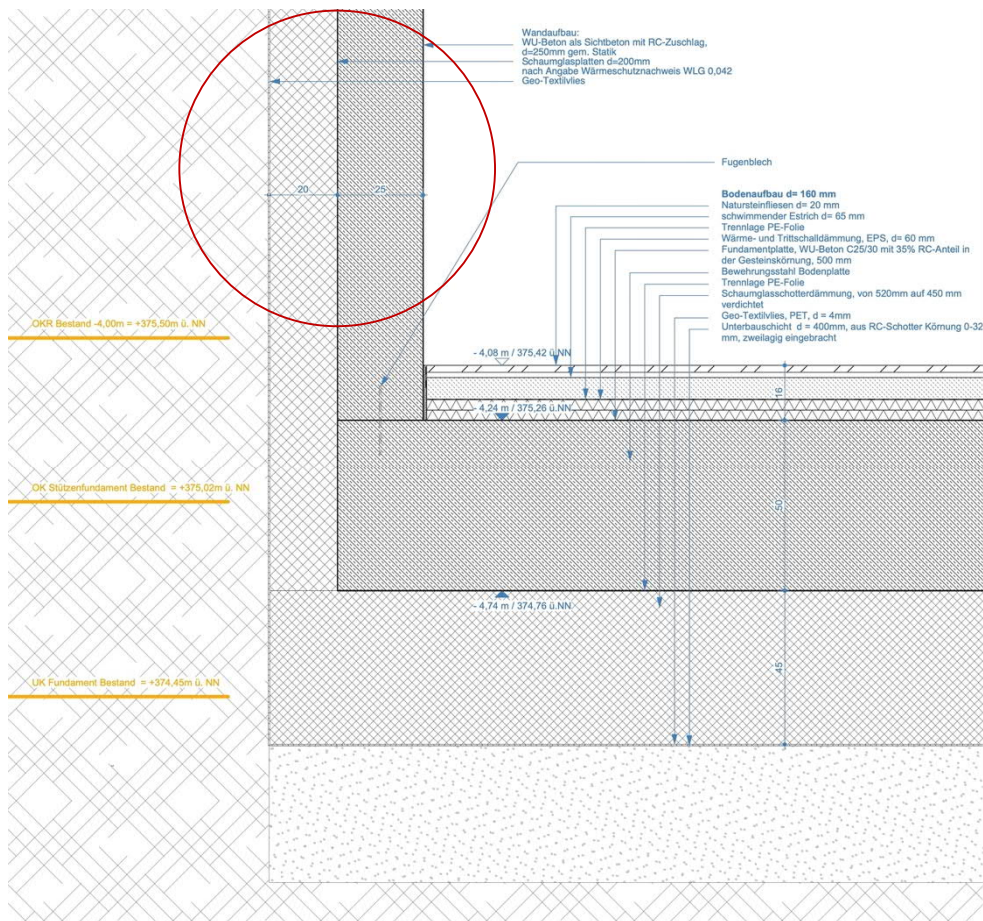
Detail Sockelanschluss / erdberührte Außenwand_umgesetzte Konstruktion
